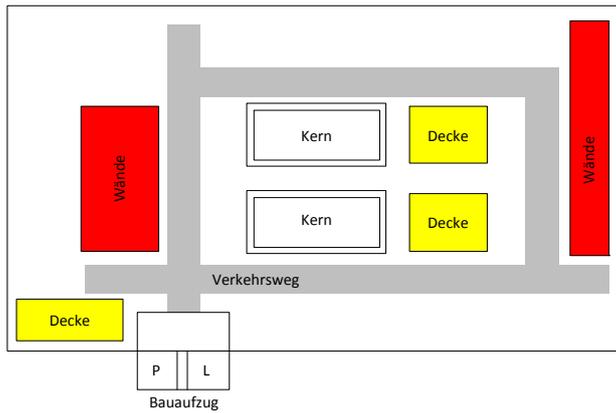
Stockwerkklagerplan – Ausbau II: Wände, Decke
